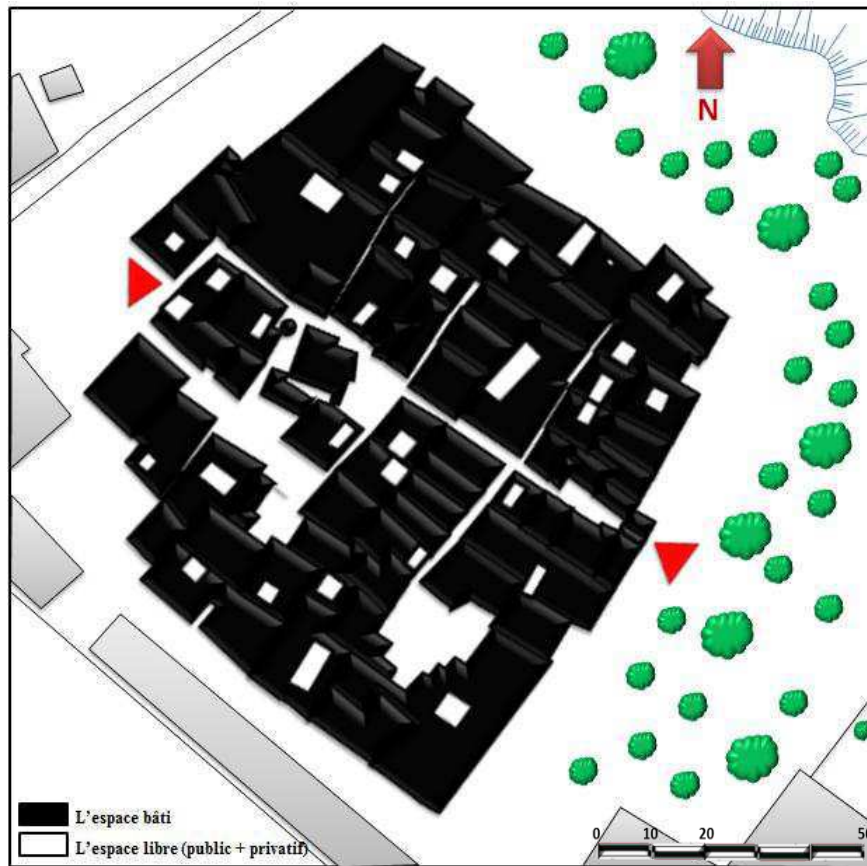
Plan de l'espace bâti et l'espace libre de ksar D'El-Haouita
